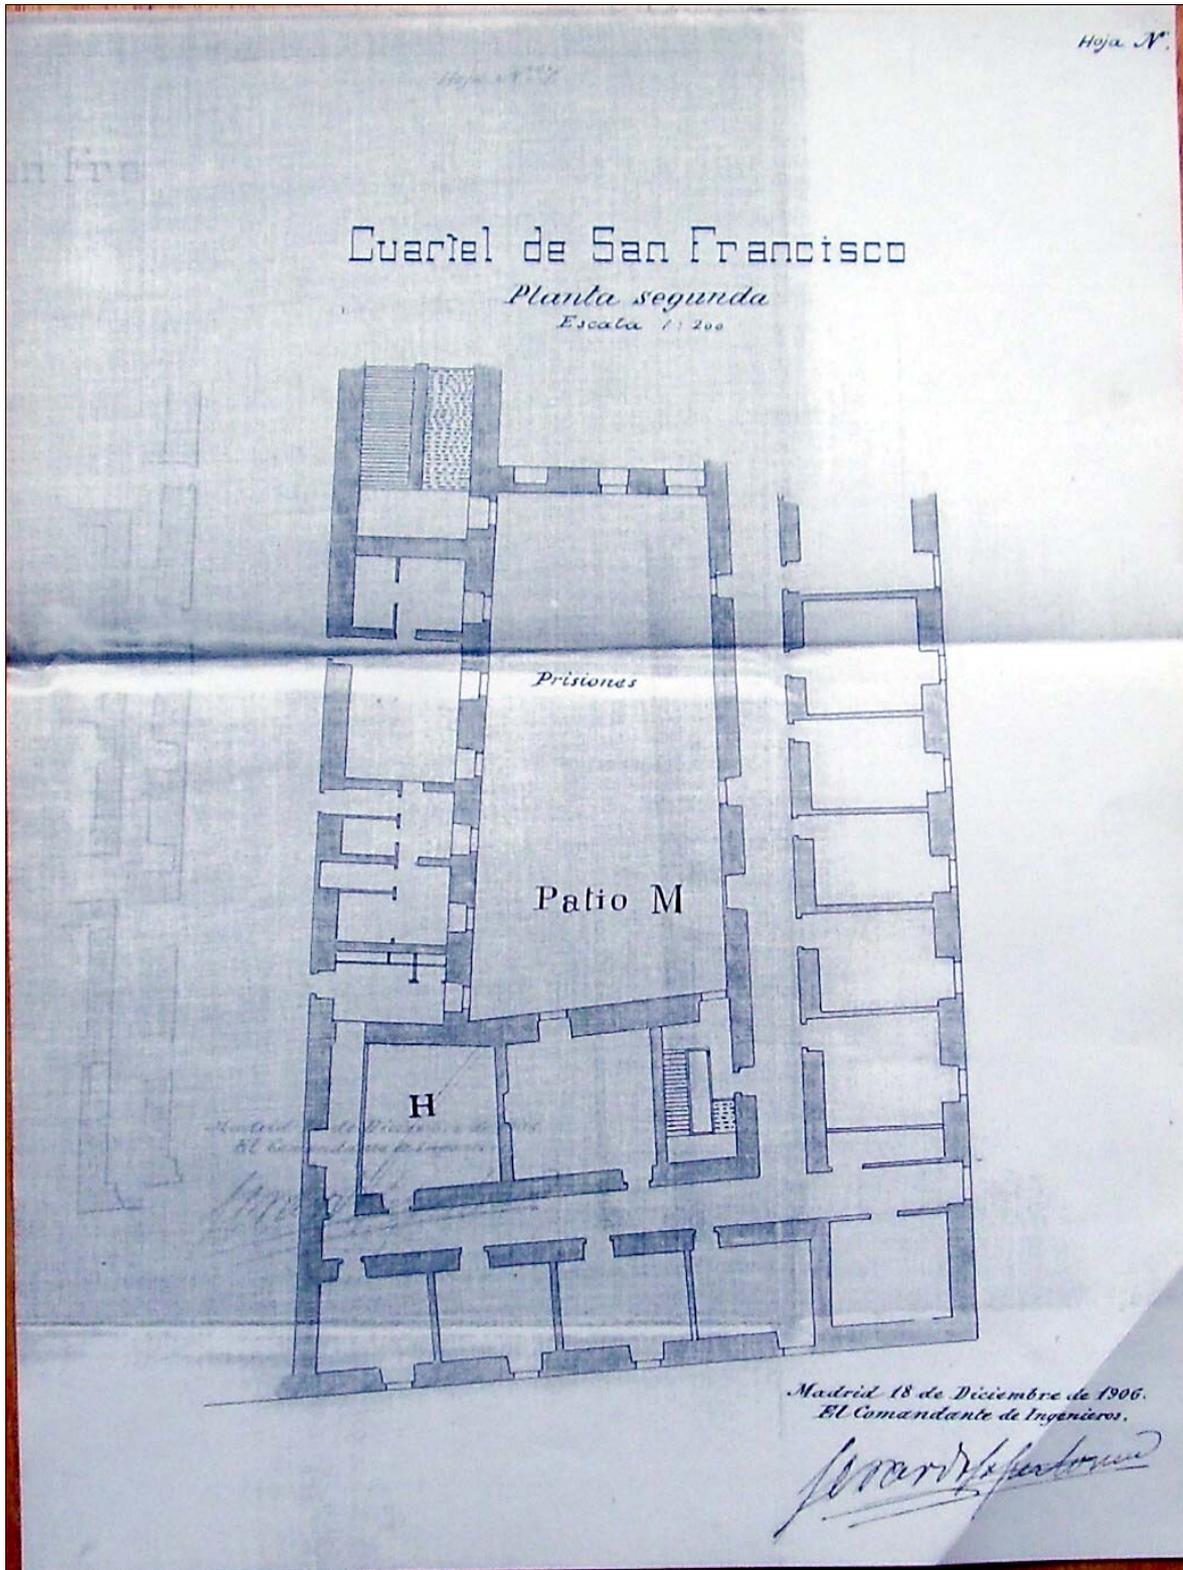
Cuartel de San Francisco. Levantamiento planimétrico de planta segunda de la zona de Prisiones Militares. Escala original, 1:200. Archivo General Militar, Sección 3ª., división 3ª., leg. 580.
